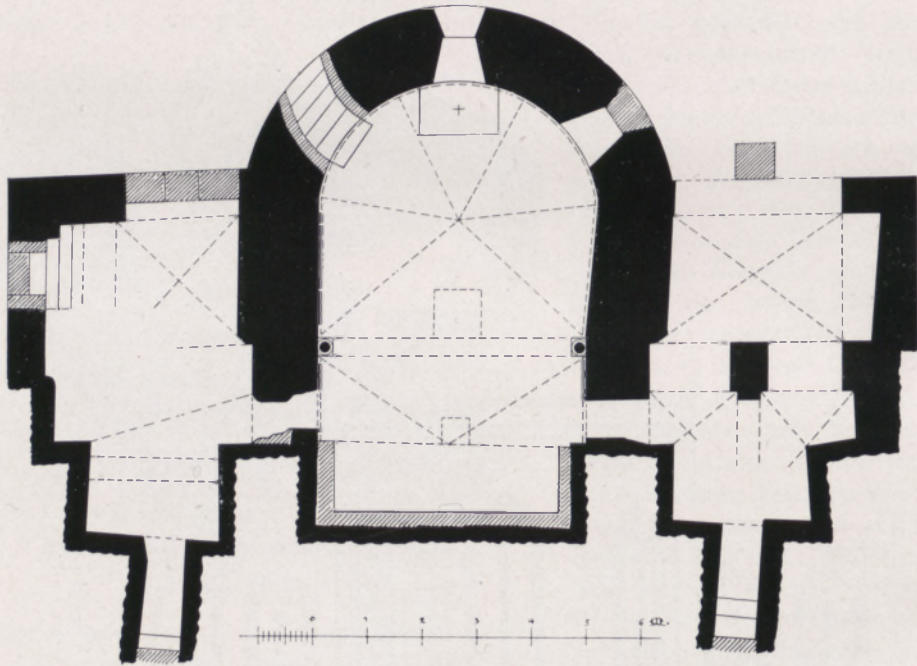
St. Maria-Lyskirchen. Grundriss der Krypta.
